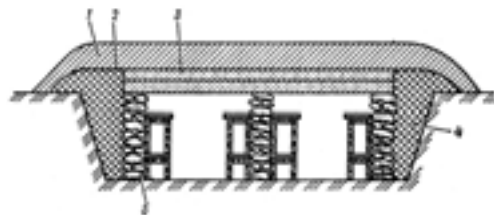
Быстровозводимое убежище со стенами из грунтонабивных мешков и перекрытием из железобетонных плит: 1 – насыпной грунт; 2 – гидроизоляция; 3 – железобетонная плита; 4 – грунт, утрамбованный послойно; 5 – мешки с грунтом
